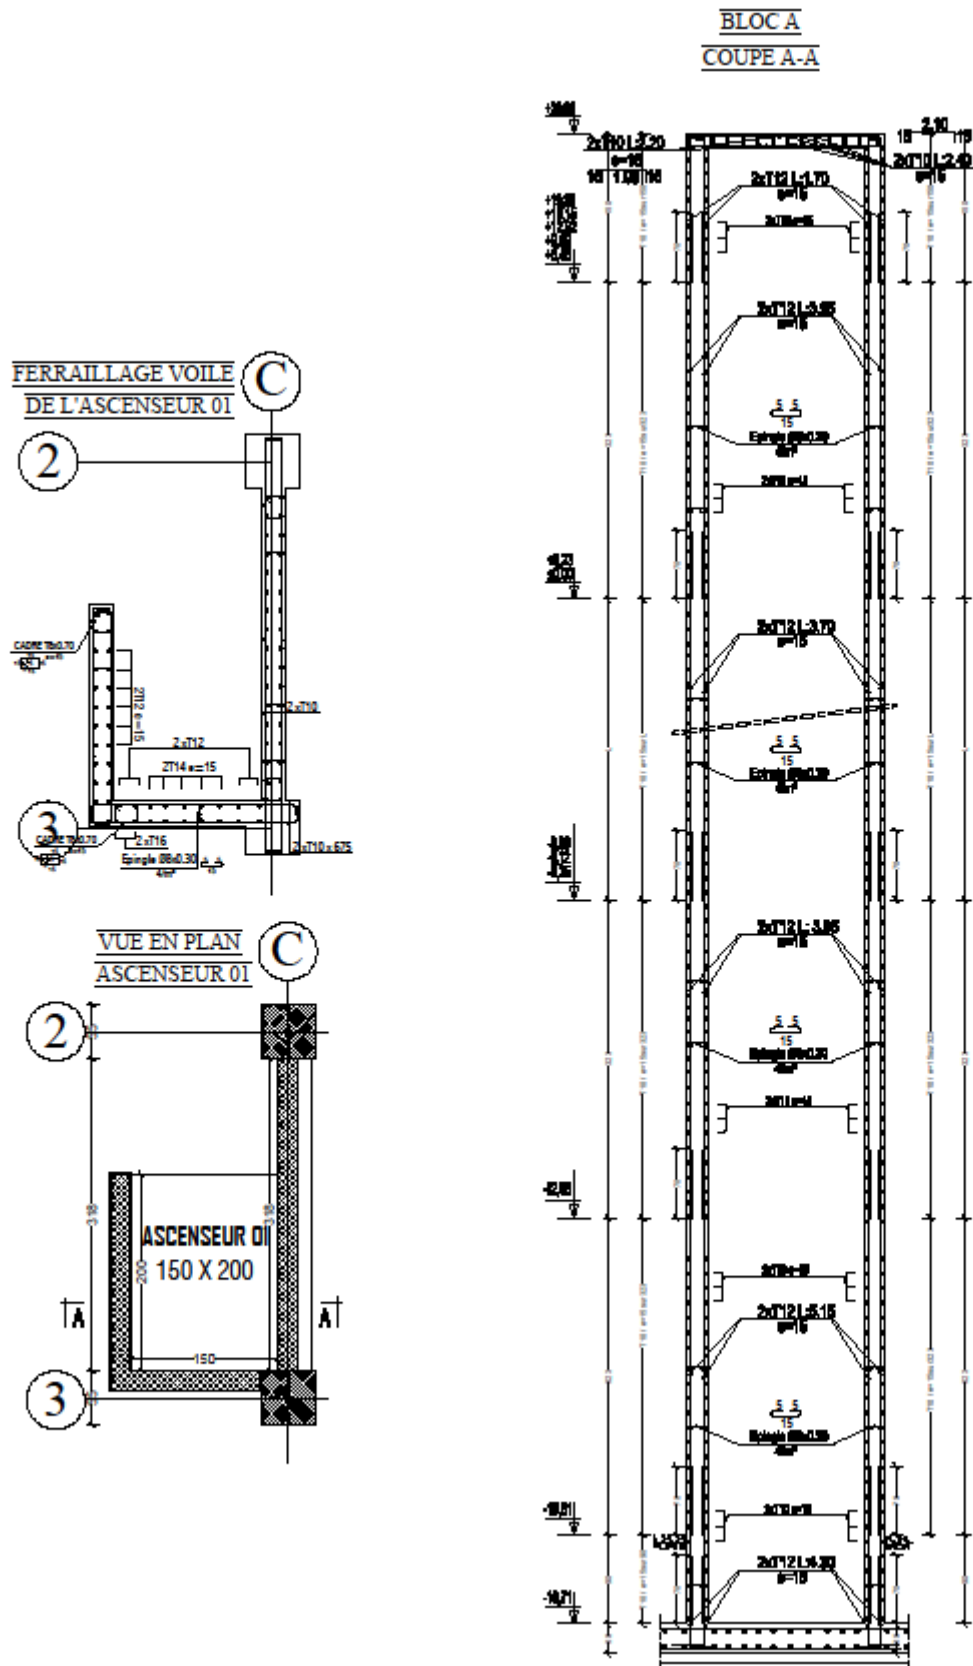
Schéma de ferrailage des voiles de la cage d'ascenseur
